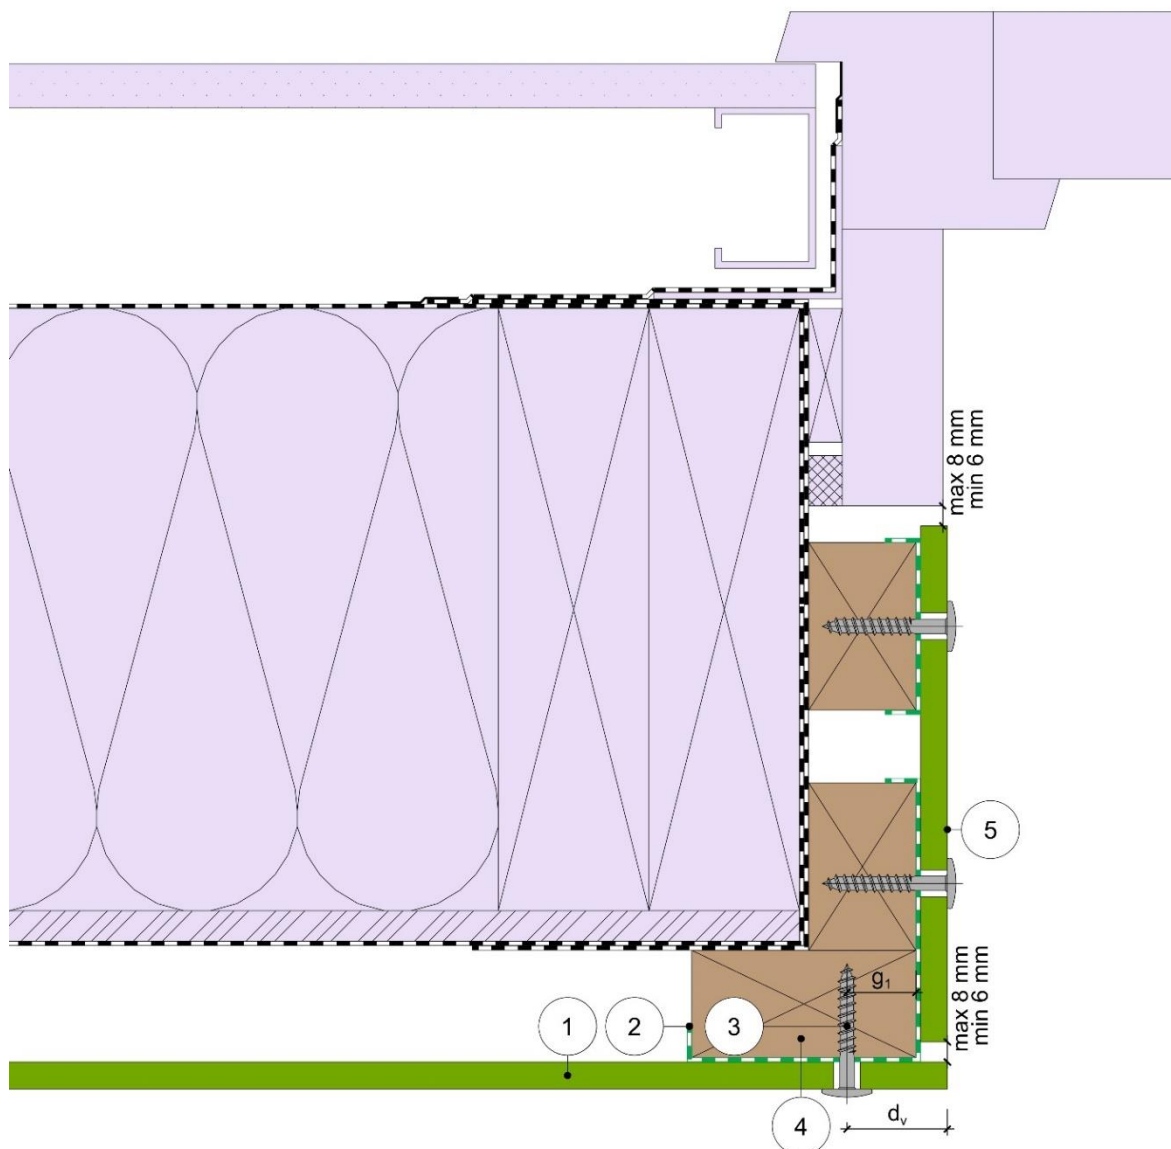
Exemple de mise en œuvre en linteau de baie – coupe verticale
